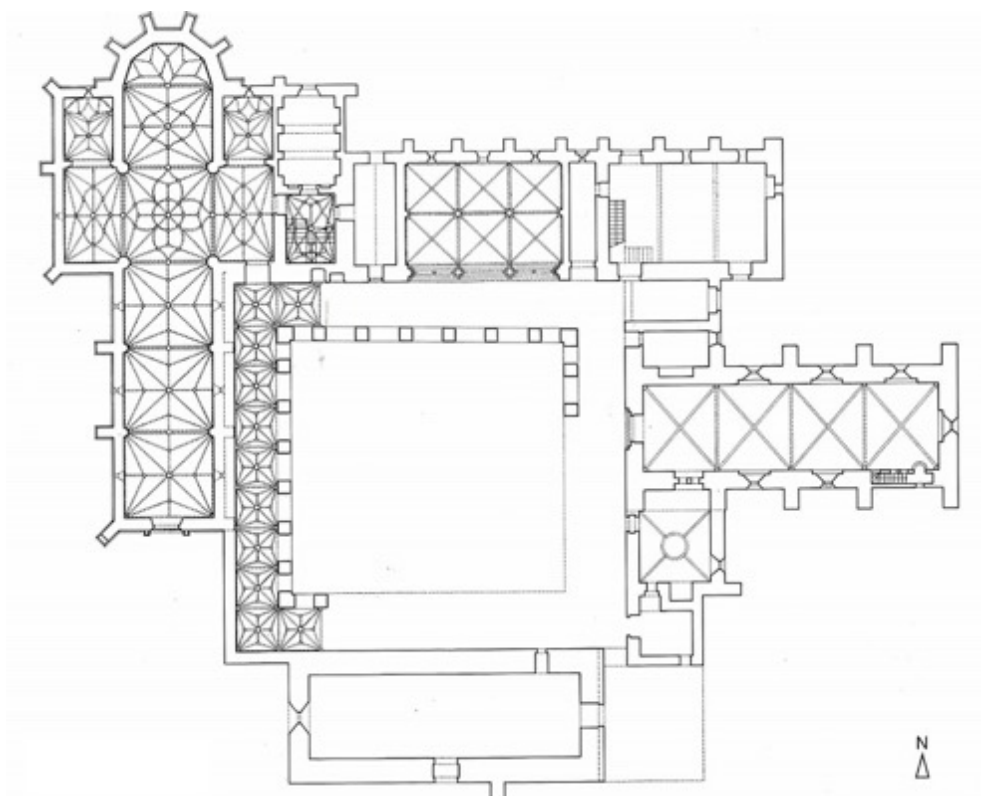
Óvila, Santa María, Grundriss Gesamtanlage nach Wiederaufbau, 15./16. Jhdt.
